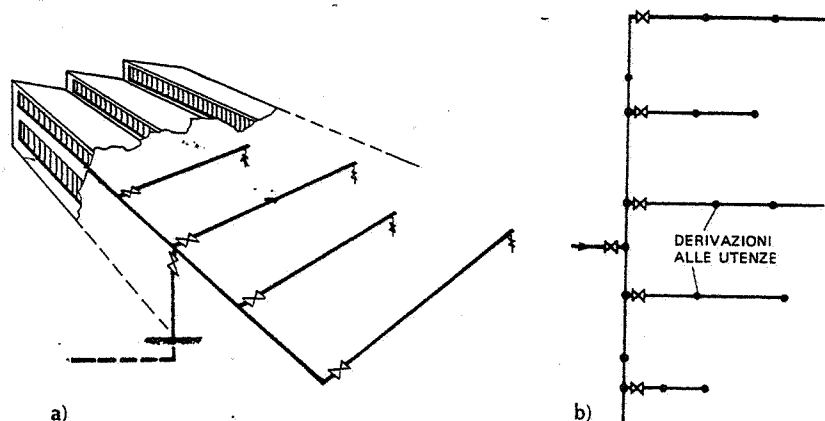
Rete a pettine: a) prospettiva; b) pianta.
